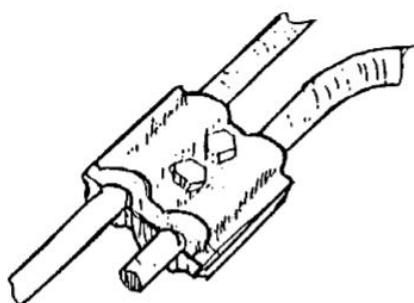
Esempi di collegamento ai ferri del pilastro o del plinto con piastra metallica (o con altri elementi metallici) incorporata nel getto del calcestruzzo, particolarmente adatti per elementi prefabbricati
